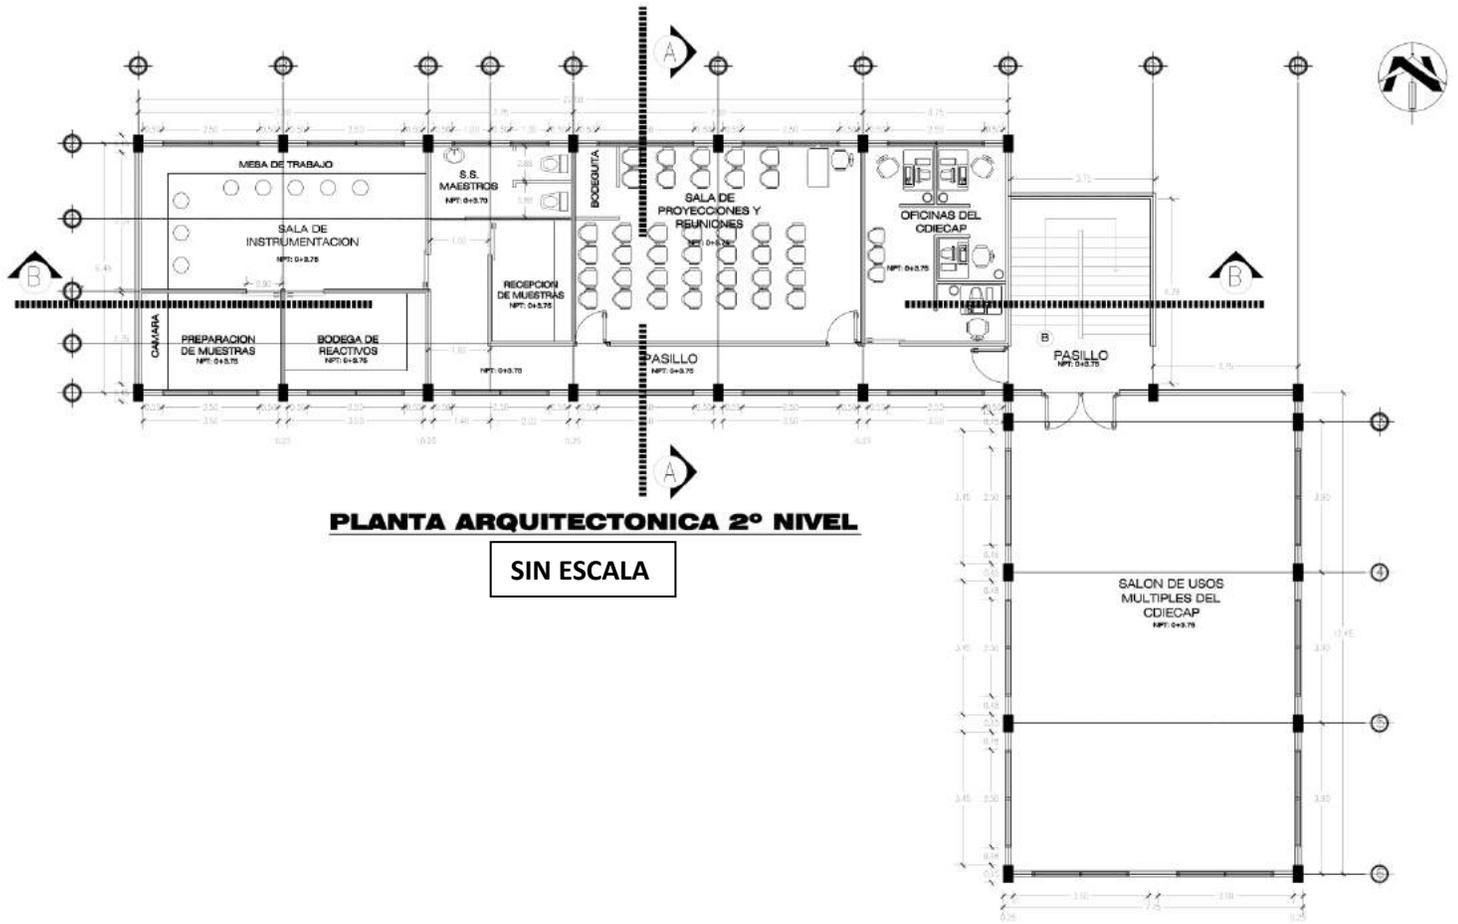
Planta Arquitectónica del Segundo Nivel - “Ampliación y Remodelación del laboratorio de Ingeniería Química y Alimentos” elaborada por: Arqta. Victoria Hernández Abrego. Fuente: Hoja A -1/4 de los planos constructivos del archivo proporcionado por Ing. Tania Torres como parte de la documentación antecedente del tema.
